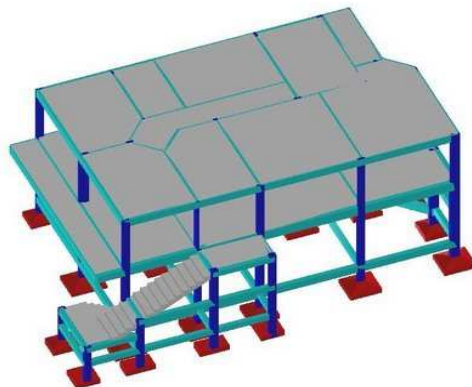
Ilustração de uma estrutura convencional em concreto armado
